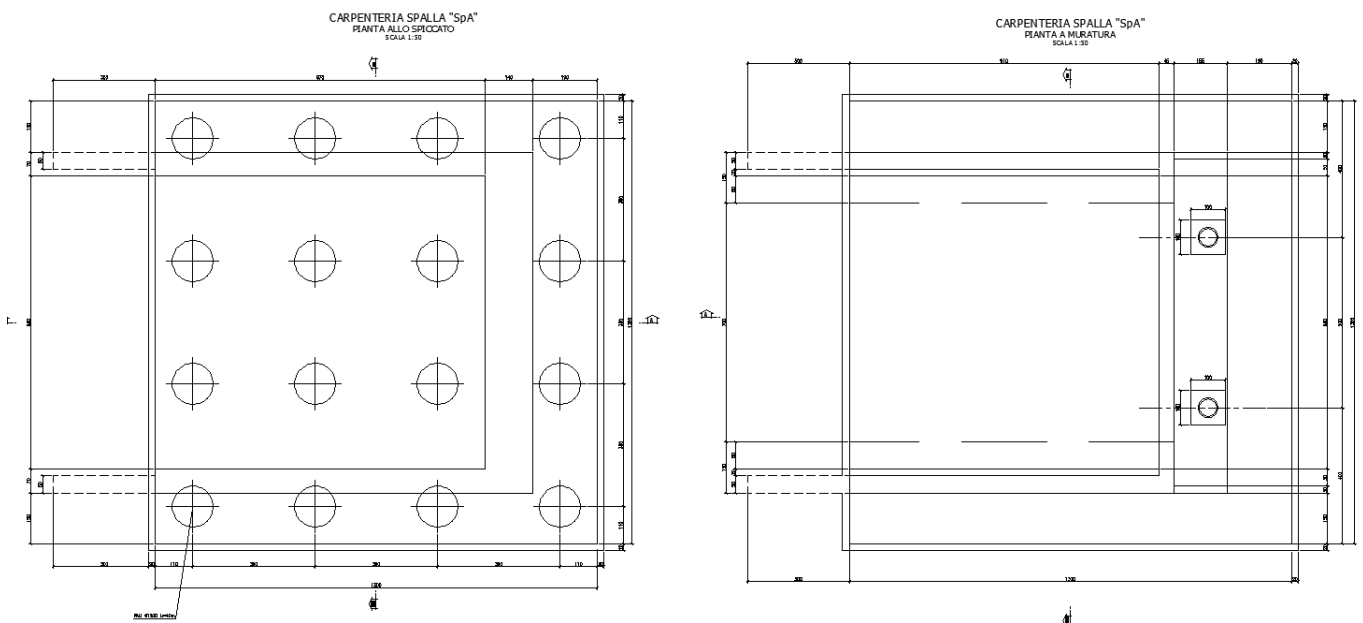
Pianta e pianta fondazioni spalla A.
